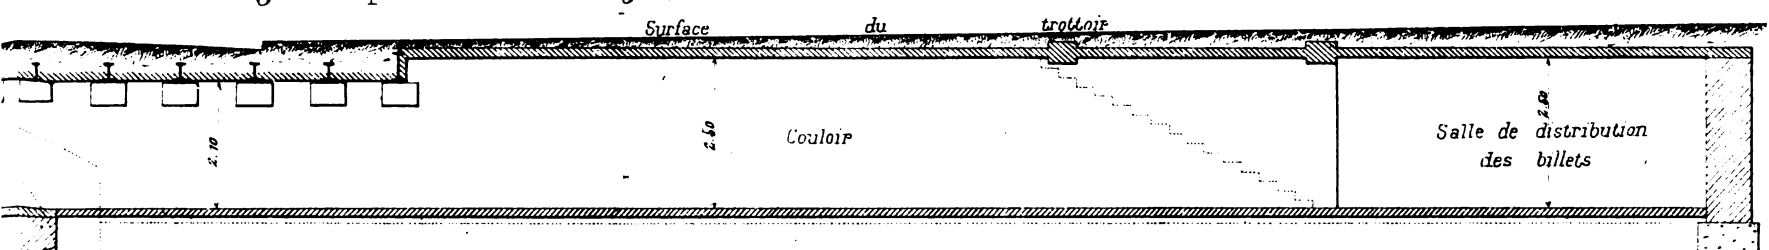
Coupe longitudinale d'une Station avec plancher métallique
